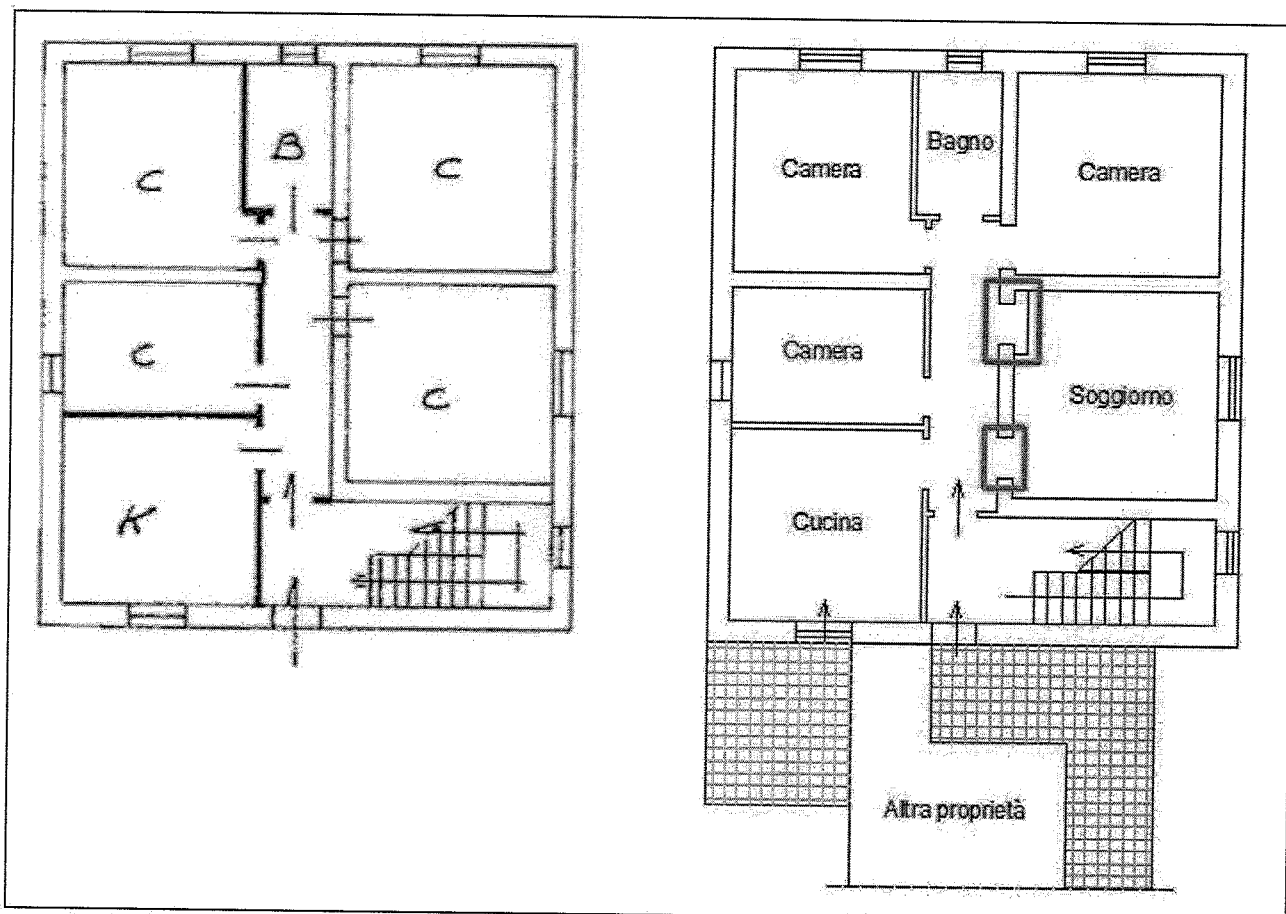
Confronto la planimetria catastale (a sinistra) e la planimetria dello stato attuale (a destra) con individuazione degli errori di rappresentazione
